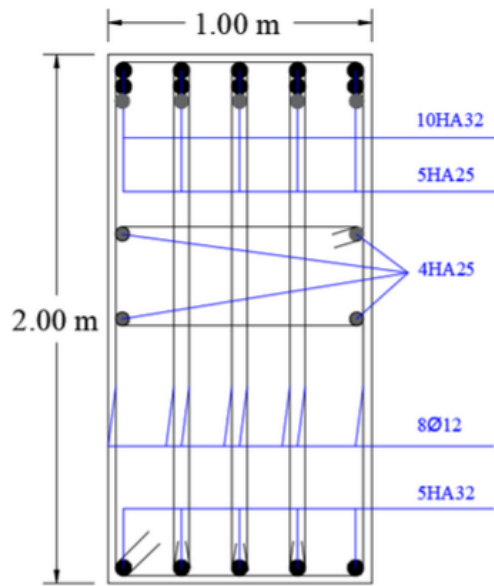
Schéma de ferrailage de la nervure du radier en travée
